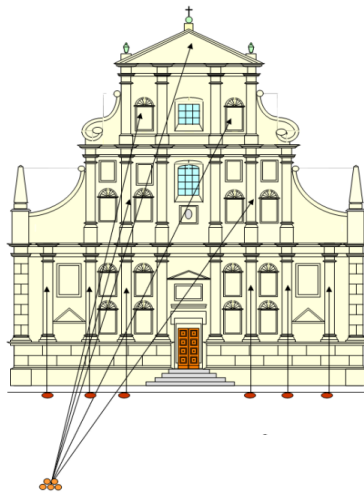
Peletakkan lampu sorotan bagi *illumination* di bangunan warisan.
